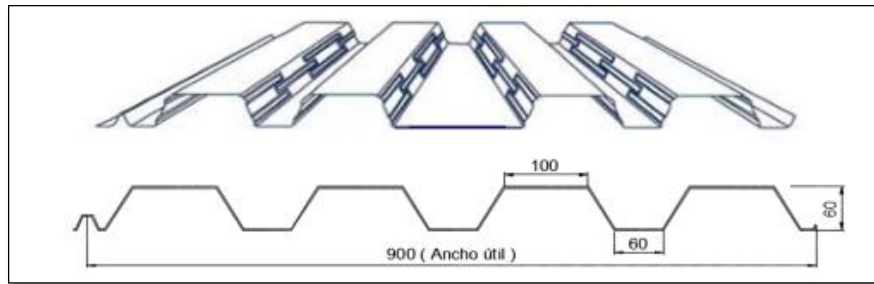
Modelo de placa Colaborante, por "Distribución y construcción Codrysac".
